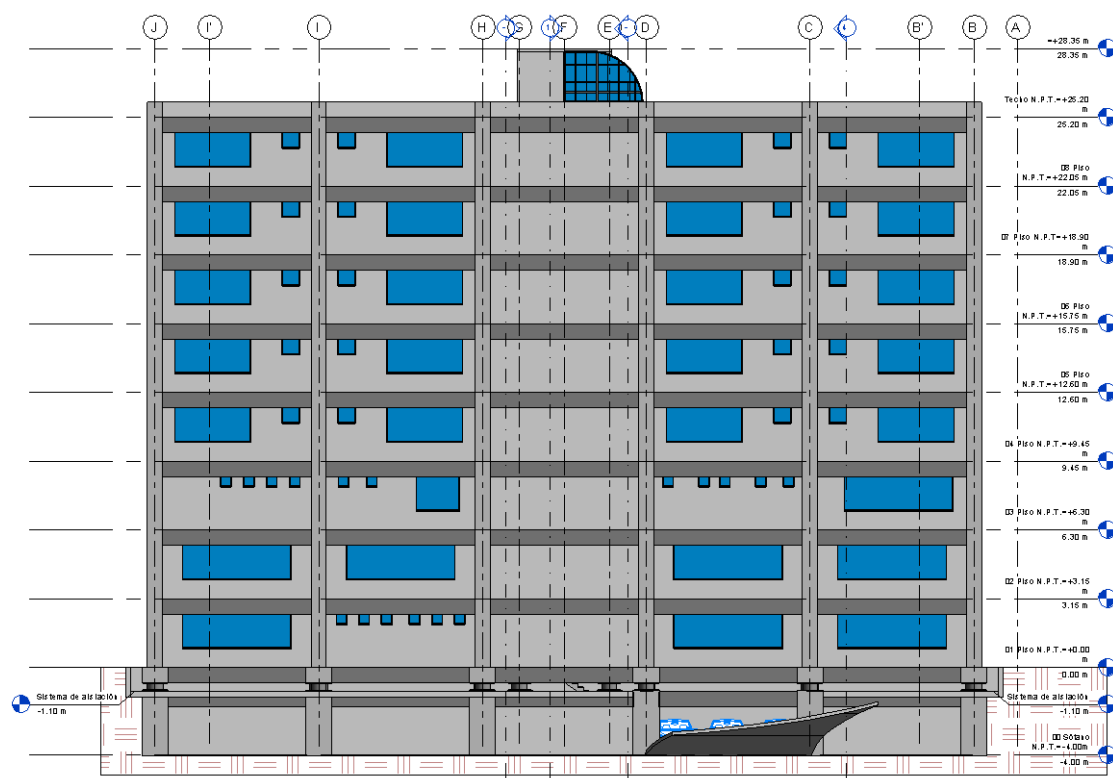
B: Vista lateral de la edificación Hotel (edificación con la incorporación del sistema de aislamiento).
